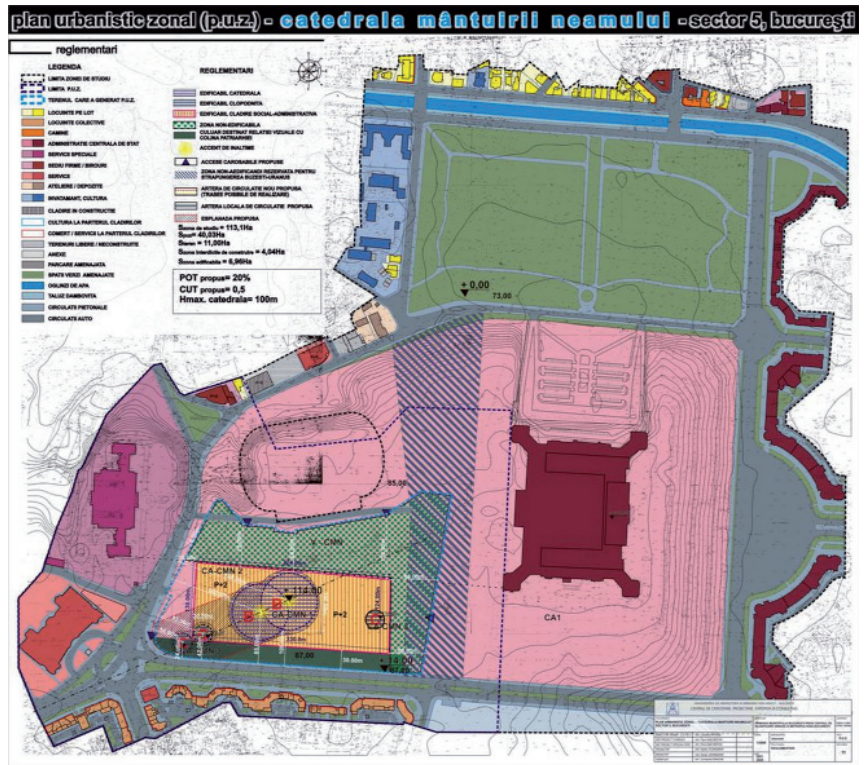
(Abajo) Sandu Hangan (alumno de Arquitectura), Catedral de la Nación, Bucarest, 2008. Proyecto.
